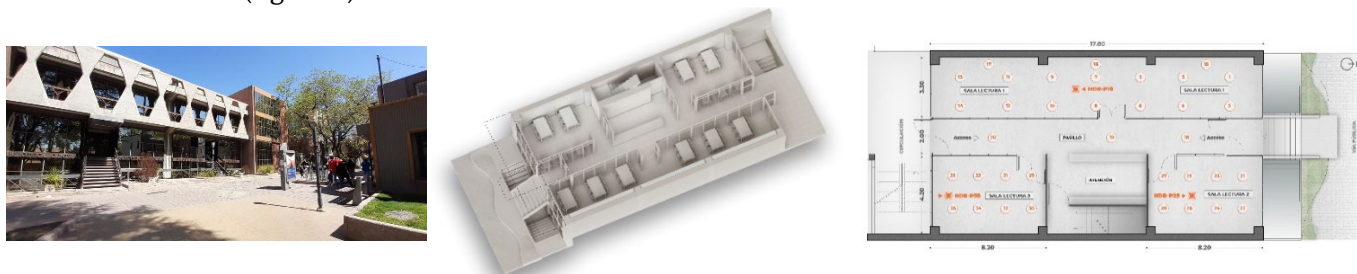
Izquierda foto fachada Biblioteca sede Universidad de Mendoza, centro axonométrica, derecha planta arquitectónica
